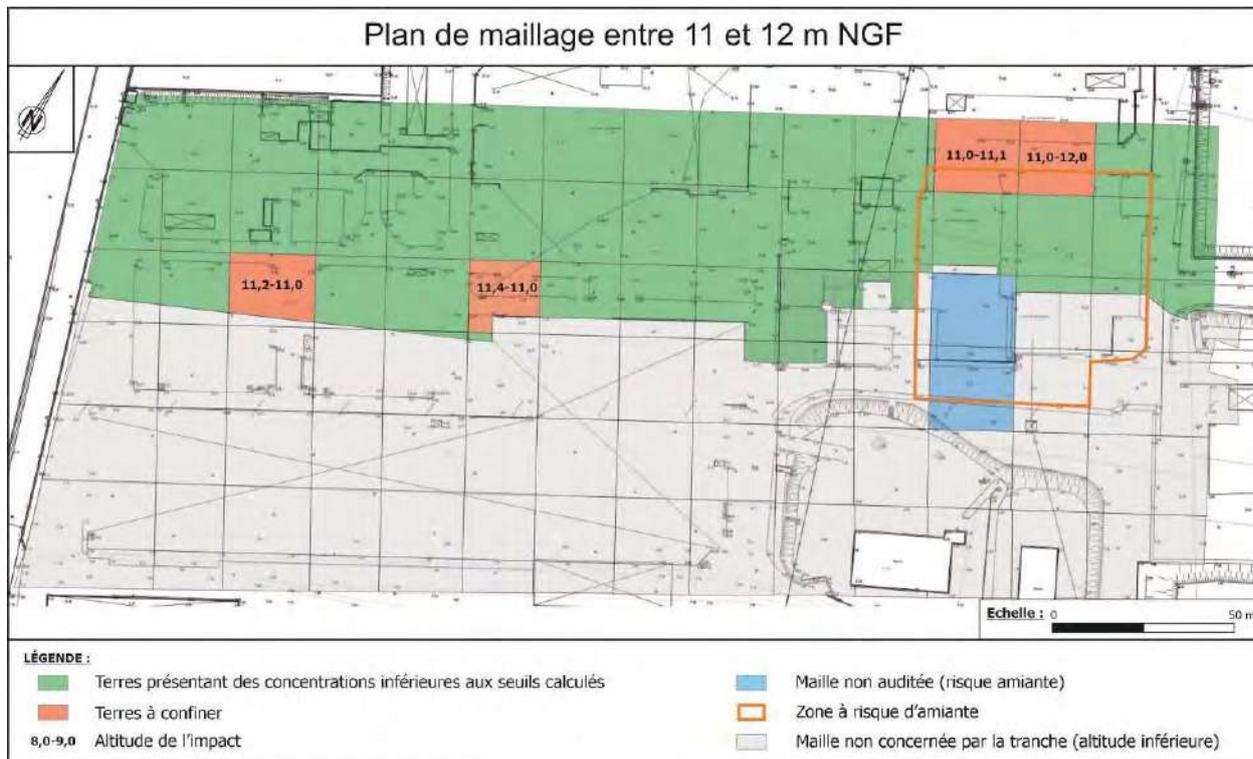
Plan de maillage entre 11 et 12 m NGF
